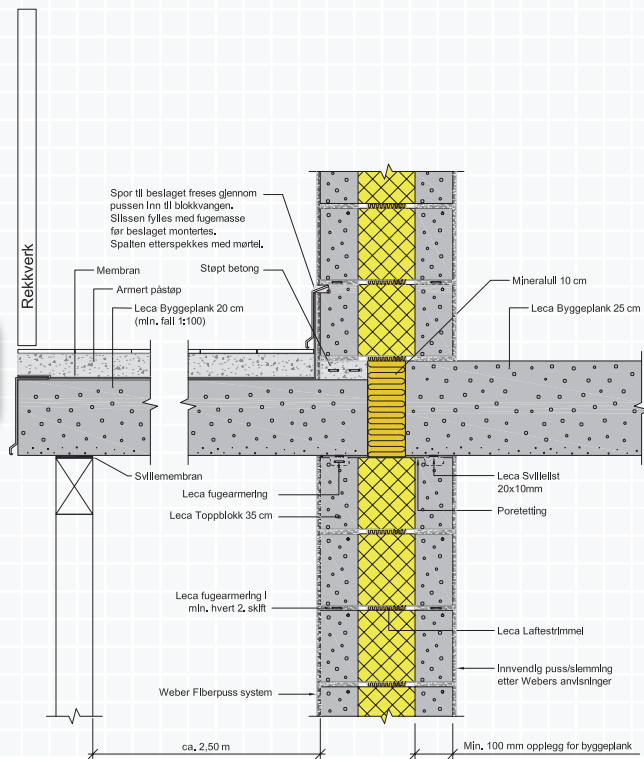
Utkraget element med innlagt armering i fuge.
